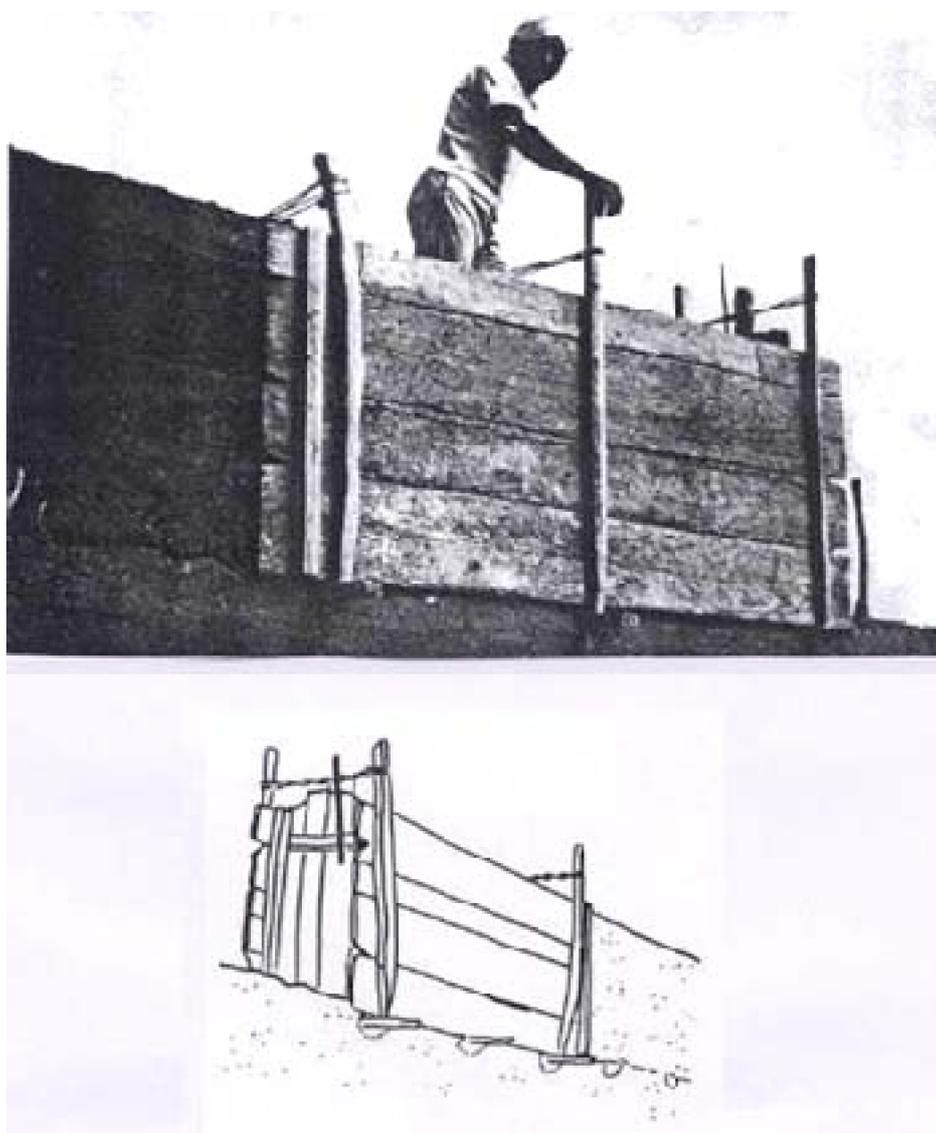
Le montage d'un mur en □ □ biya. Coffrage (l □ □) en bois utilisé pour la construction d'un mur en □ □ biya.
